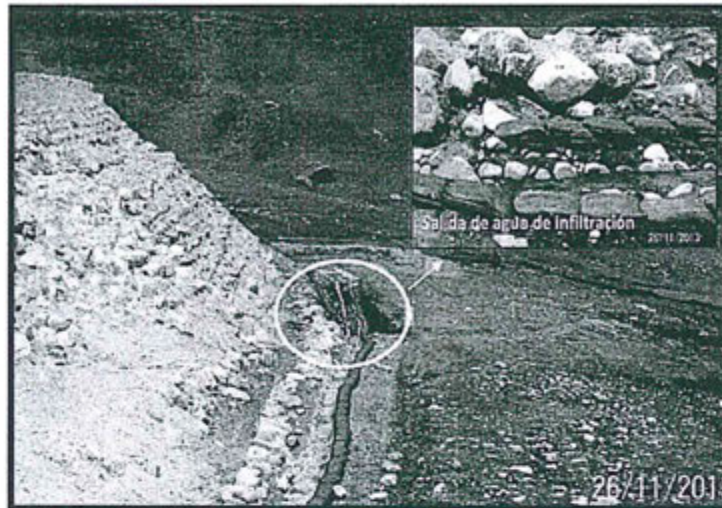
Hallazgo N° 2. Vista del canal ubicado en la parte baja de la planta de concreto (UNICON) que captan las aguas de infiltración de la plataforma donde se ubica dicha planta, las aguas captadas en dichos canales se juntan con las aguas que conectan los canales internos.
